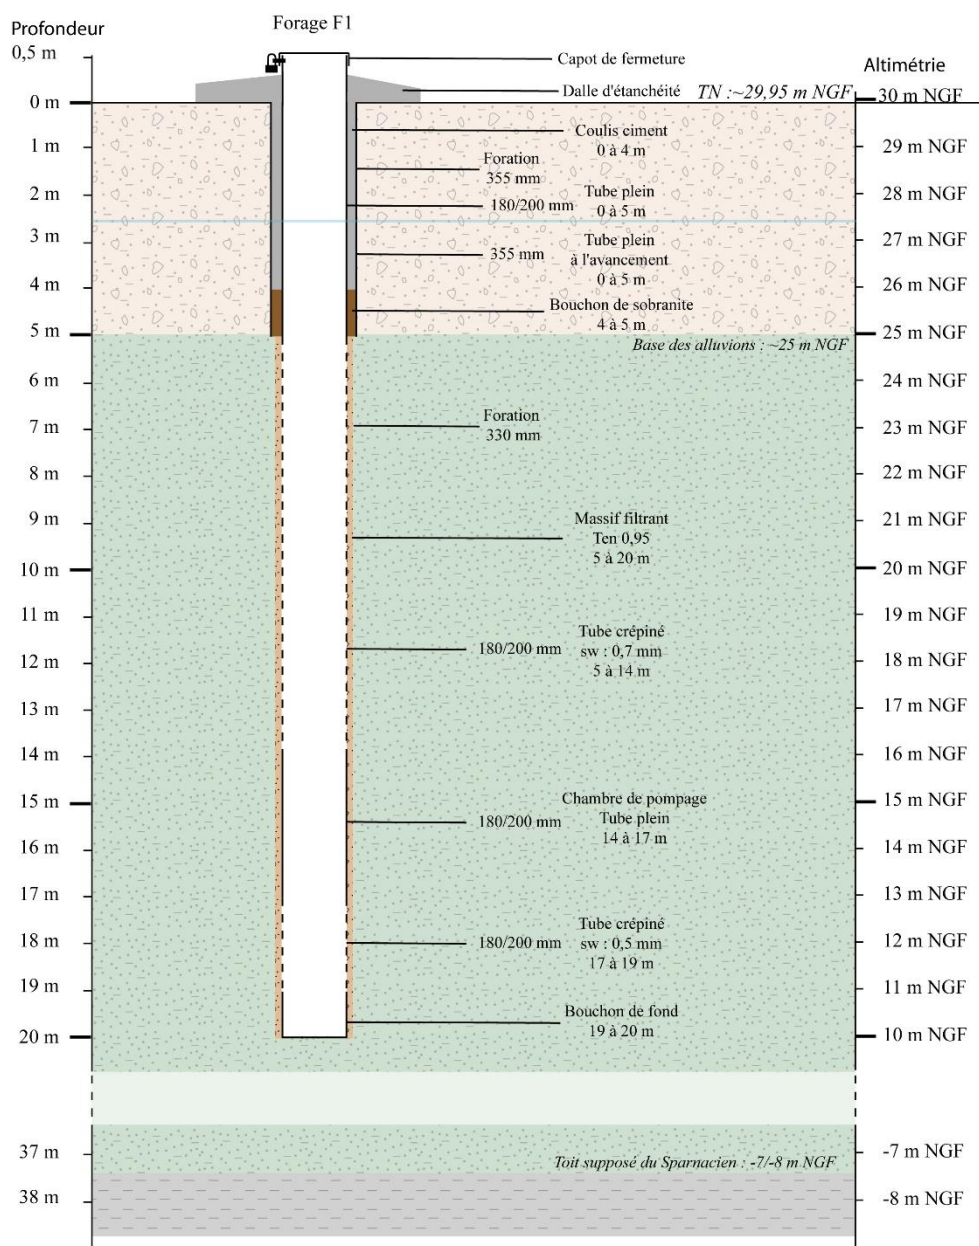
Coupe technique prévisionnelle de l'ouvrage
